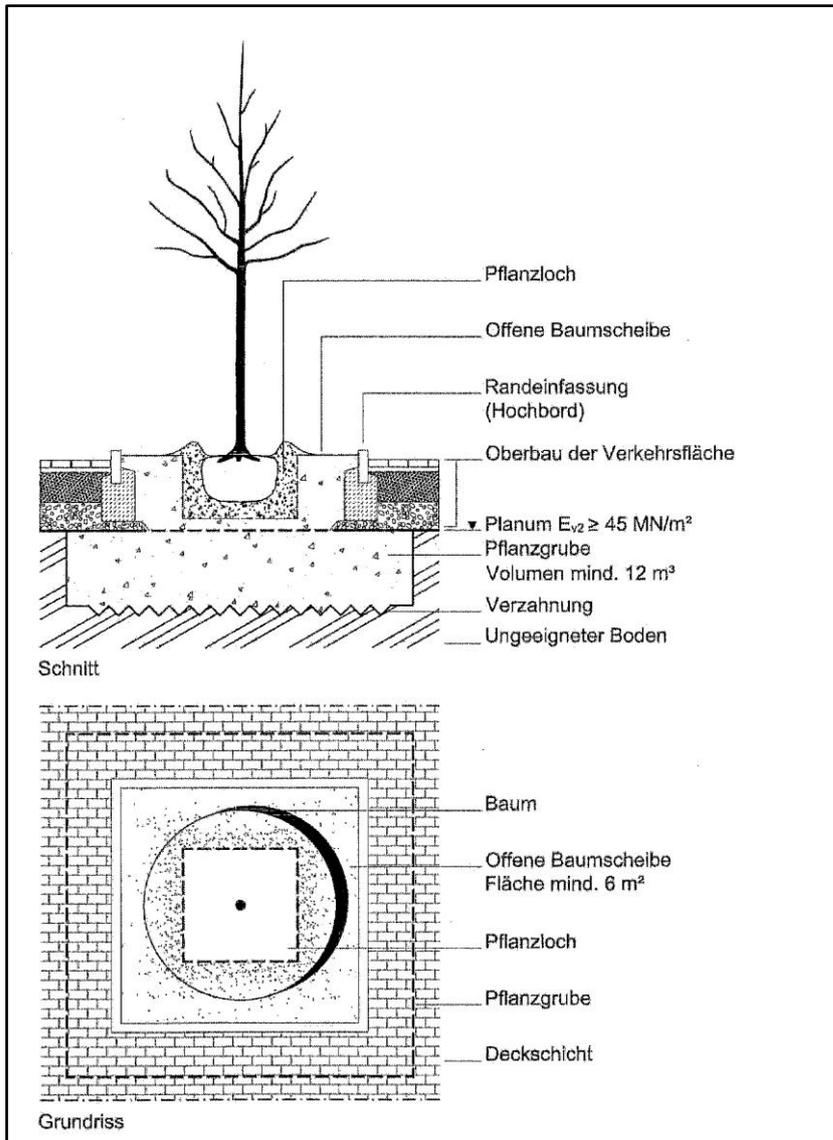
Pflanzgrubenbauweise 2 - überbaute Pflanzgrube bei für die Baumpflanzung ungeeigneten Bodenverhältnissen (Anwendungsbeispiel: Pflanzgrube mit offener Baumscheibe im Bereich von PKW-Stellplätzen)
